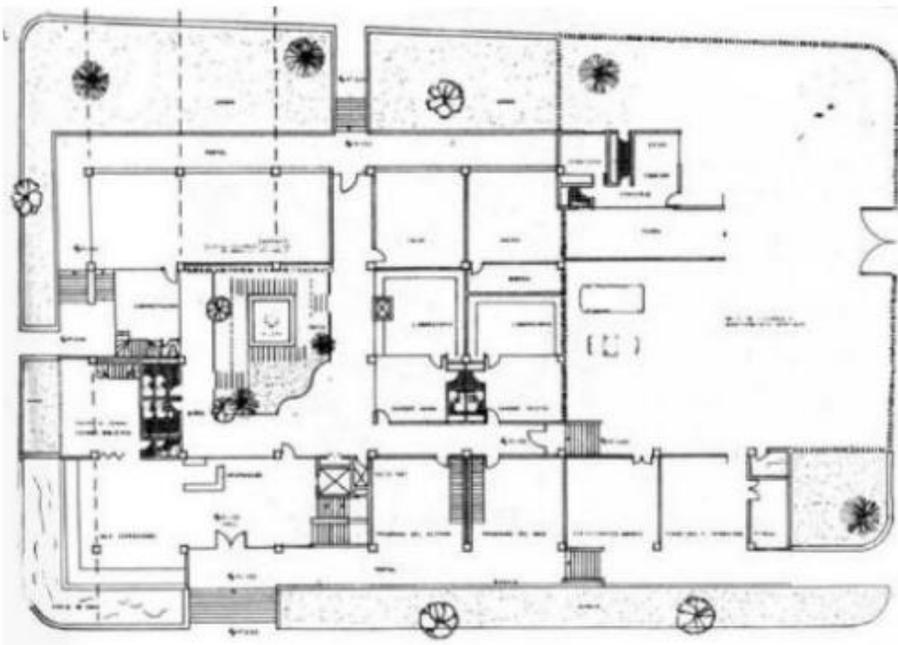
| Plano de planta baja, MAG. Fuente: Libro BAQ, 1980.
